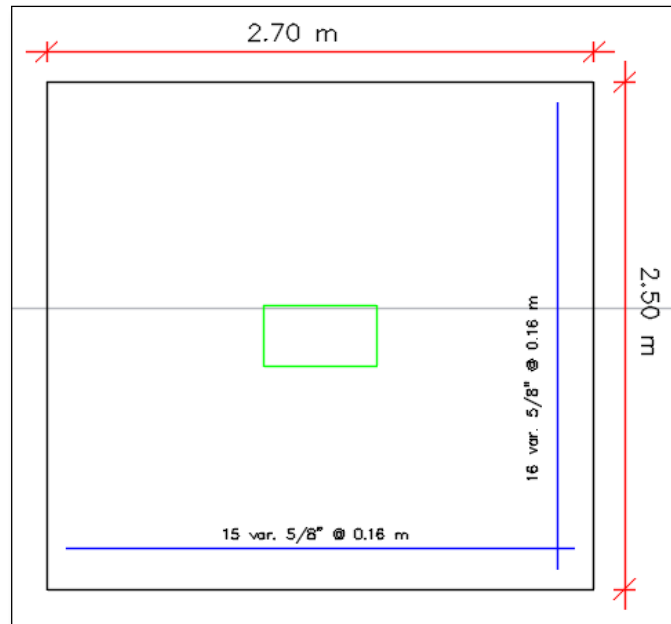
Vista en planta de zapata aislada para pedestal céntrico.
